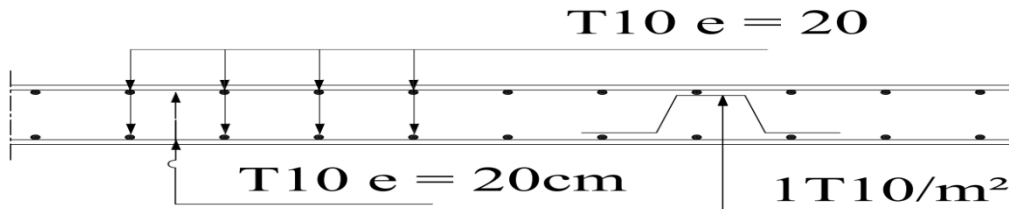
Schéma de ferrailage de la dalle machine d'ascenseur
